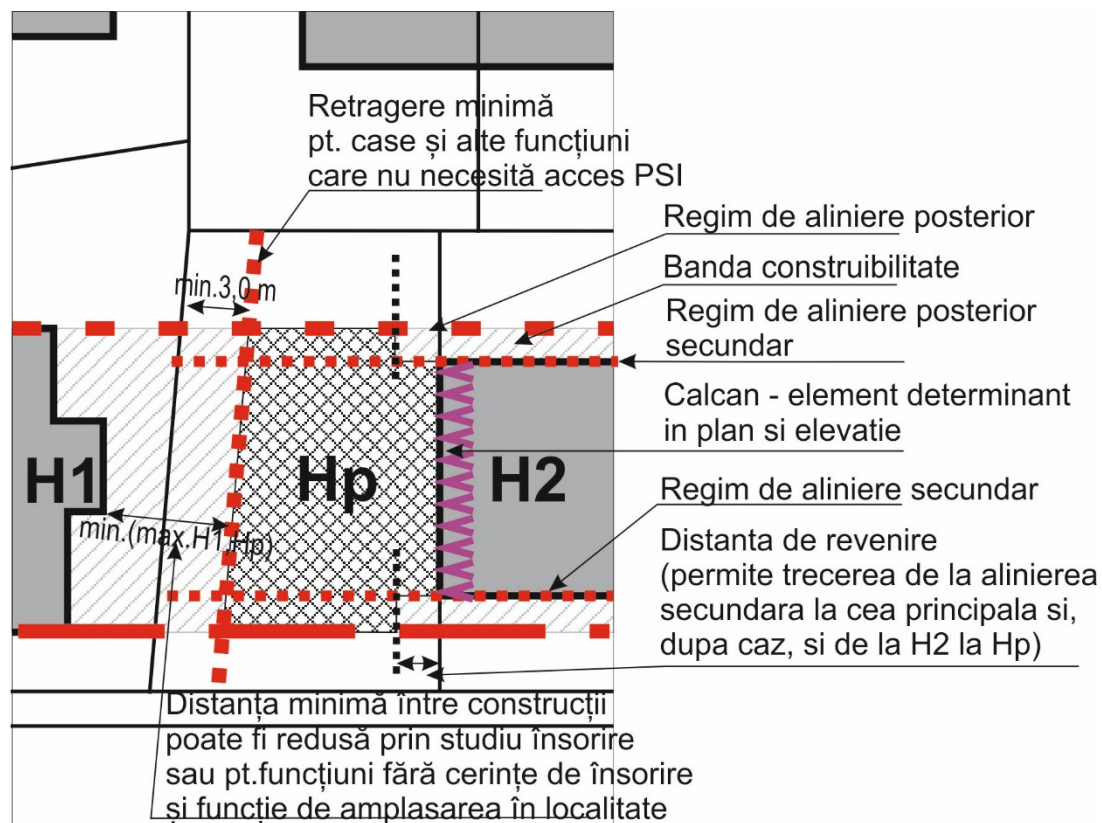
Exemplificarea modului de stabilire a limitelor edificabilului în țesut existent, pentru locuințe joase
